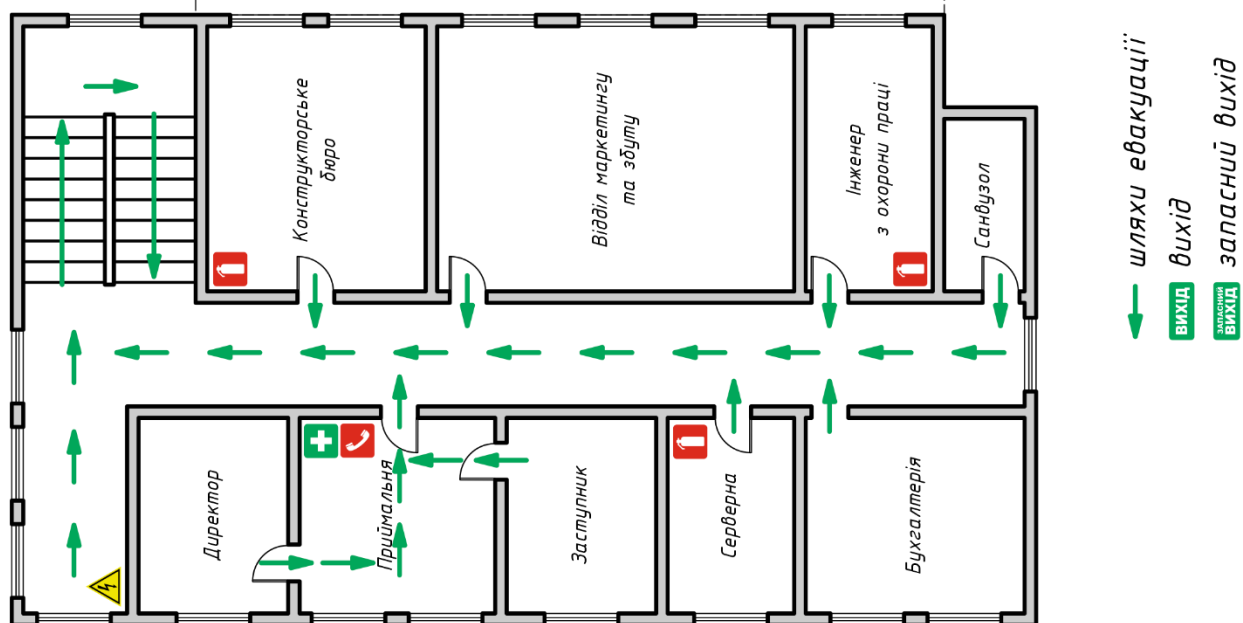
План евакуації із 2 поверху будівлі на випадок пожежі
